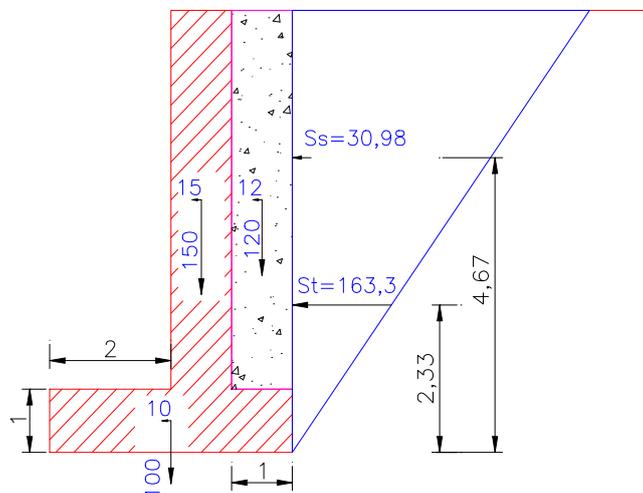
Spinta statica e sismica per verifiche fondazione
